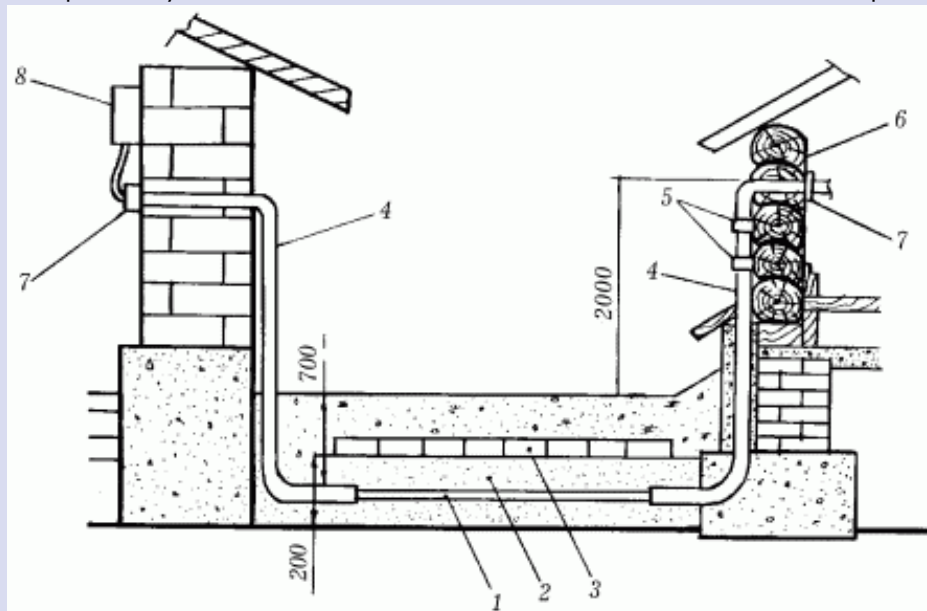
Ввод кабельный в деревянное здание: 1 – кабель (прокладывается в траншее на глубине от поверхности земли не менее 0,7 м, в огороде – не менее 1 м); 2 – подсыпка из мелкого просеянного песка толщиной не менее 10 см; 3 – кирпич, уложенный поперек траншеи на утрамбованную подсыпку (в местах возможного механического повреждения кабеля); 4 – стальная труба; 5 – скобы; 6 – стена дома деревянная; 7 – втулка фарфоровая; 8 – электросчетчик.
